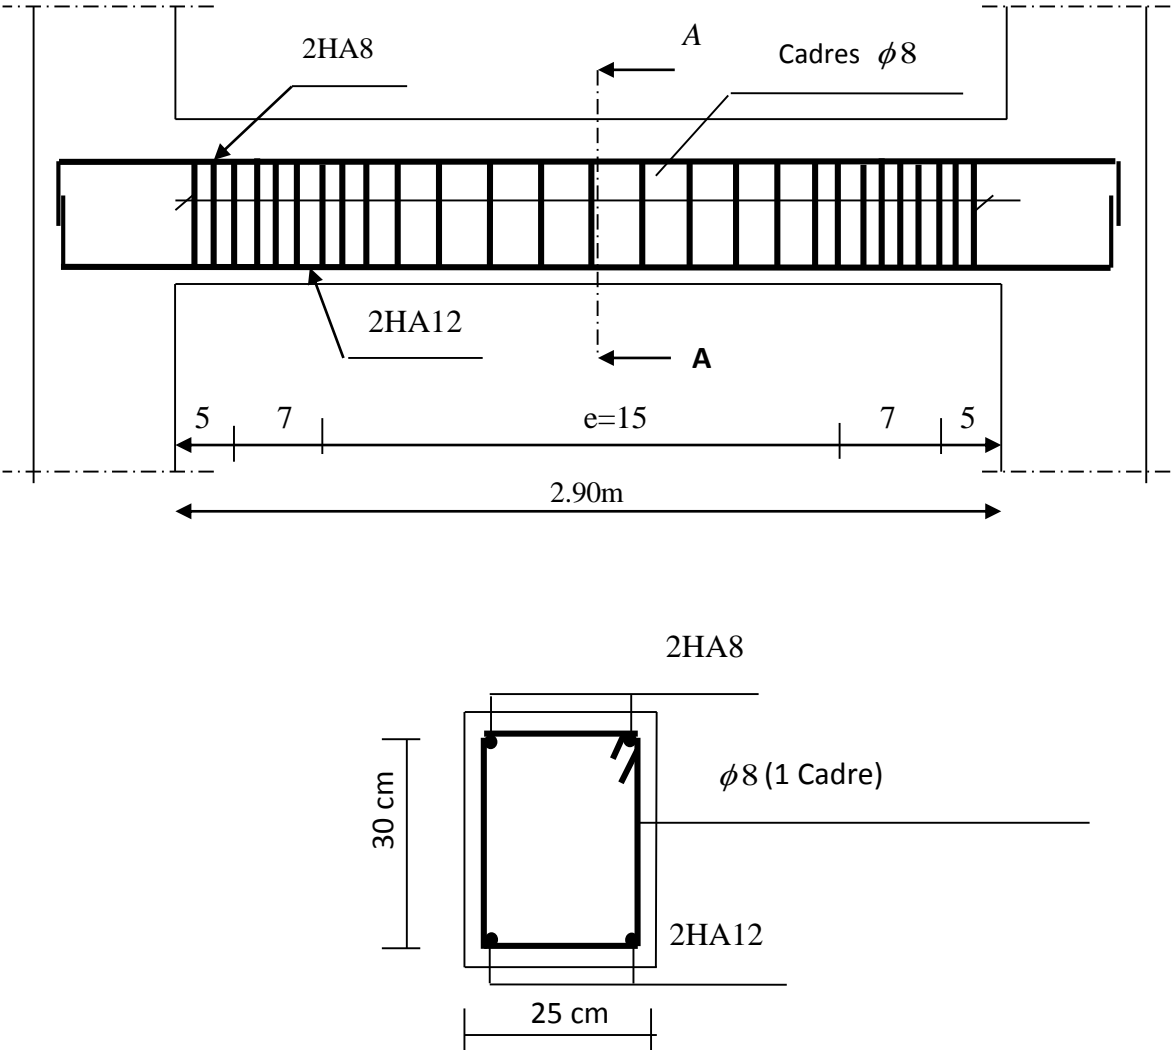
Ferrailage de la poutre de chaînage II.
